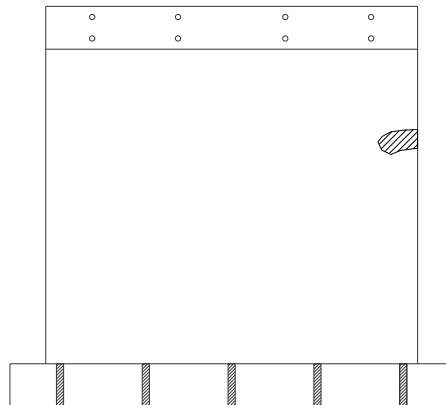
Reparación tipo I en muro de albañilería confinada con ladrillos sólido artesanal en la distorsión 1/3000.
